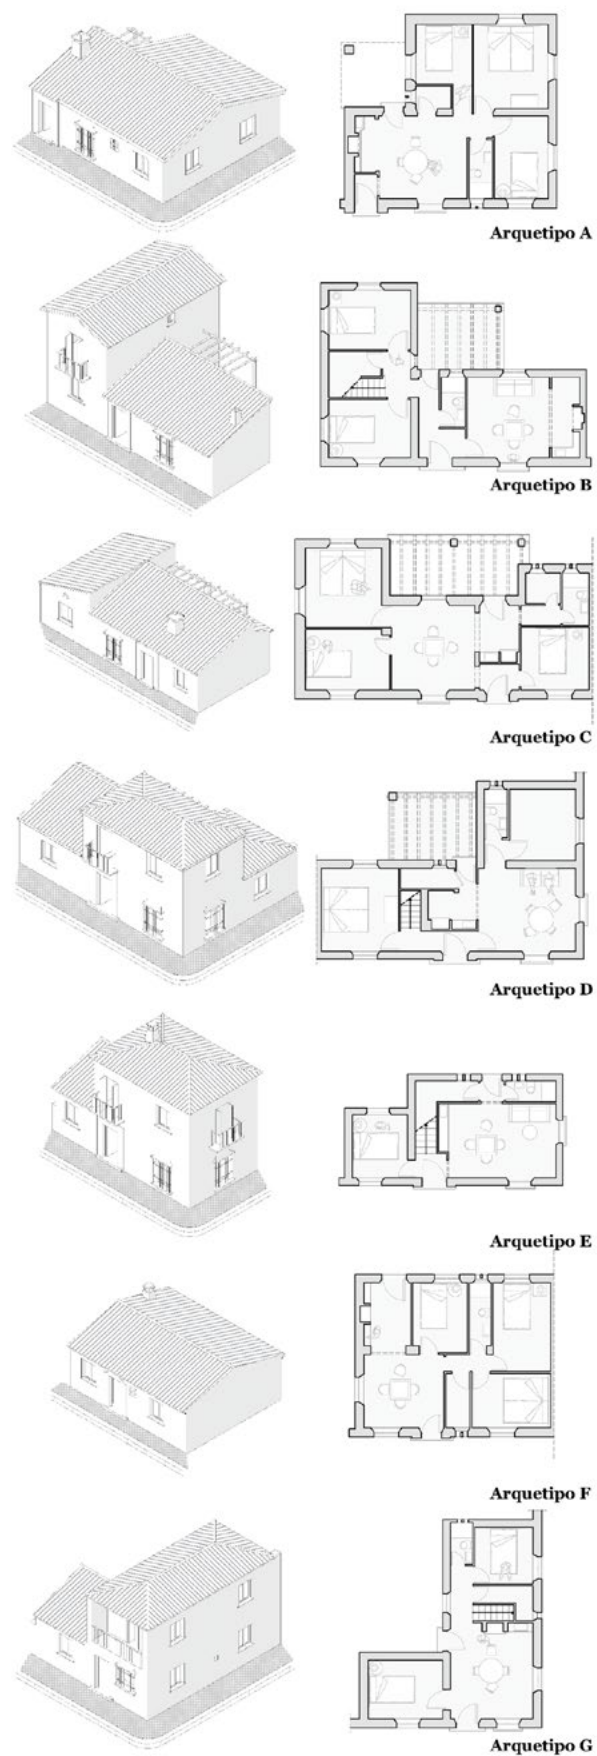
Planta baja de los arquetipos residenciales identificados en los pueblos proyectados por José García-Nieto Gascón. Elaboración propia.
